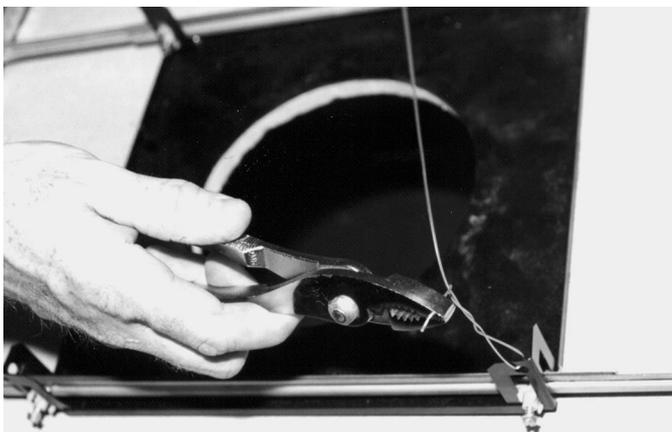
Découpe d'un trou dans la dalle de plafond
